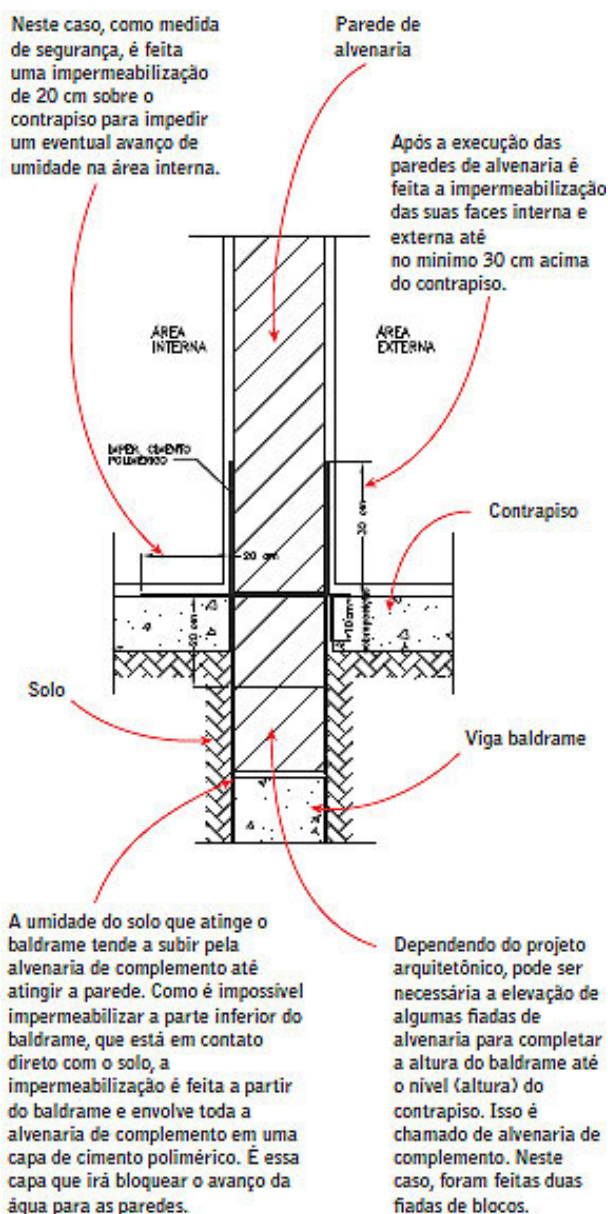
Detalhamento impermeabilização no baldrame (Revista Equipe de Obra Edição 38)
